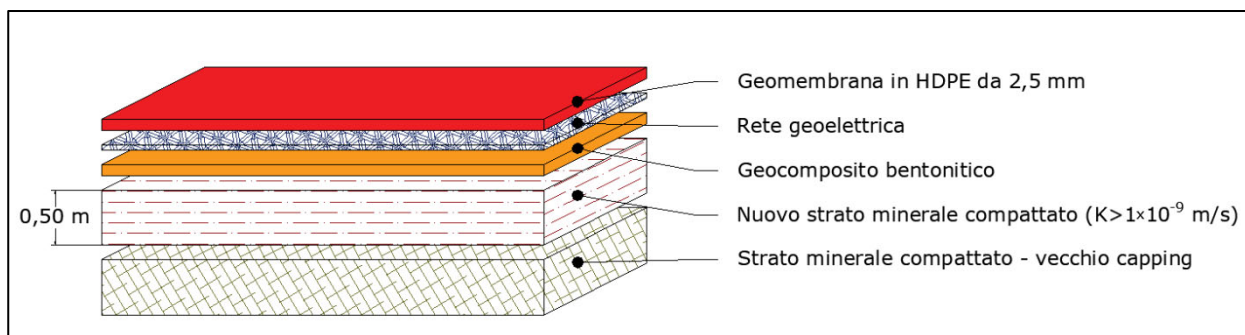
/IX: Particolare pacchetto impermeabilizzazione area generale di abbancamento
